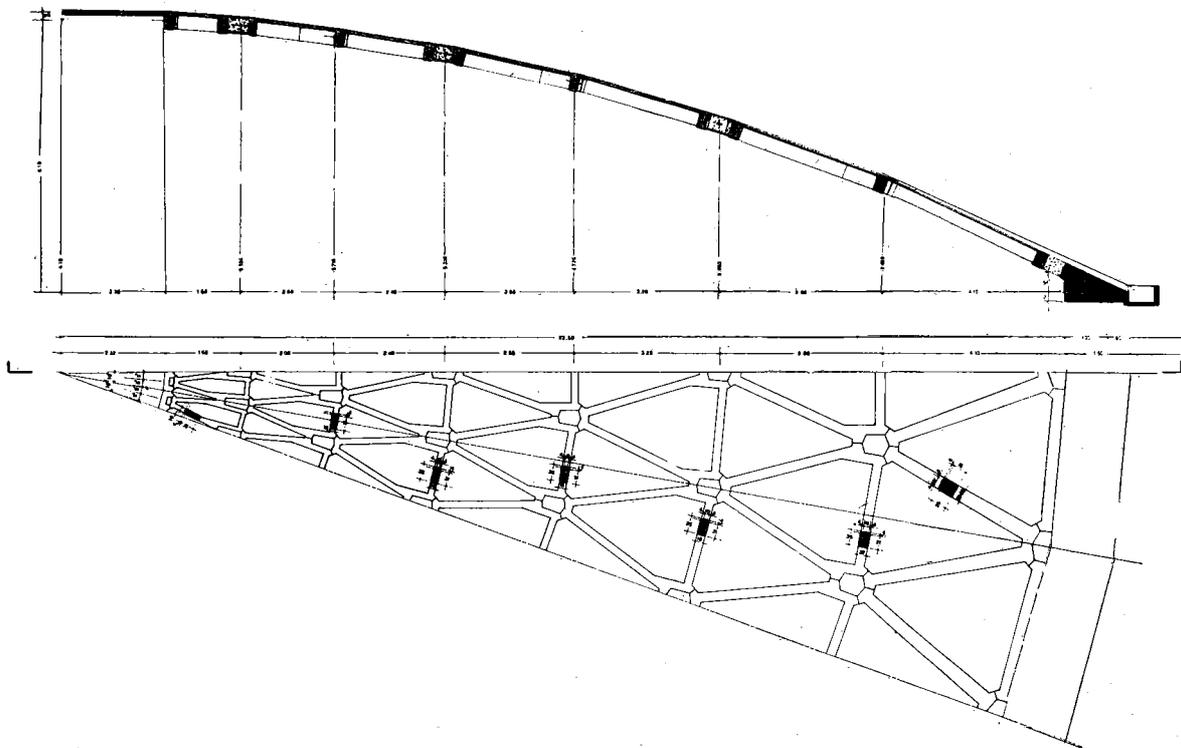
Cupola anello d'accumulazione. Pianta e sezione degli elementi prefabbricati della cupola.
